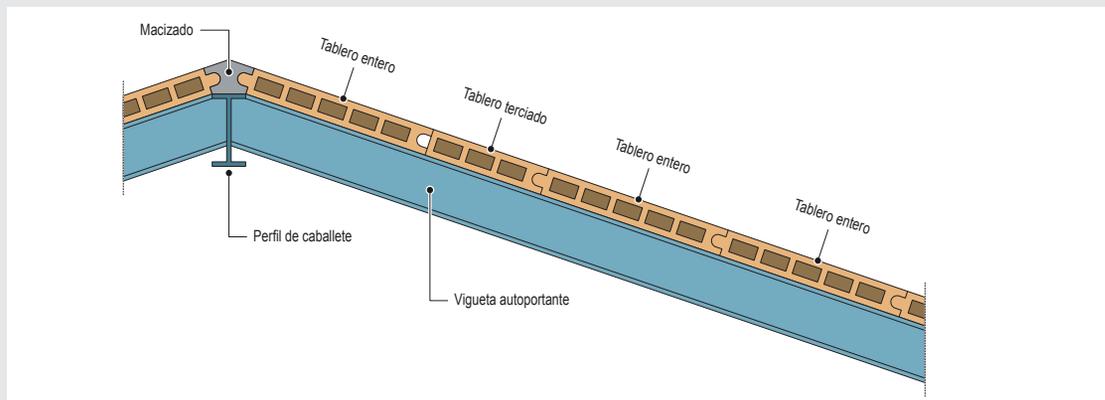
Apoyo del tablero sobre caballete en cubierta sobre viguetas autoportantes
